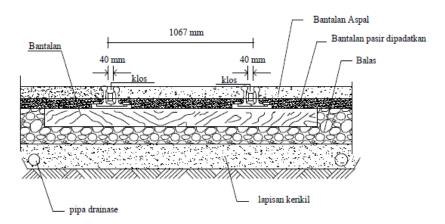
Potongan melintang perlintasan sebidang dengan plat baja (memakai penambat Pandrol) [9]
